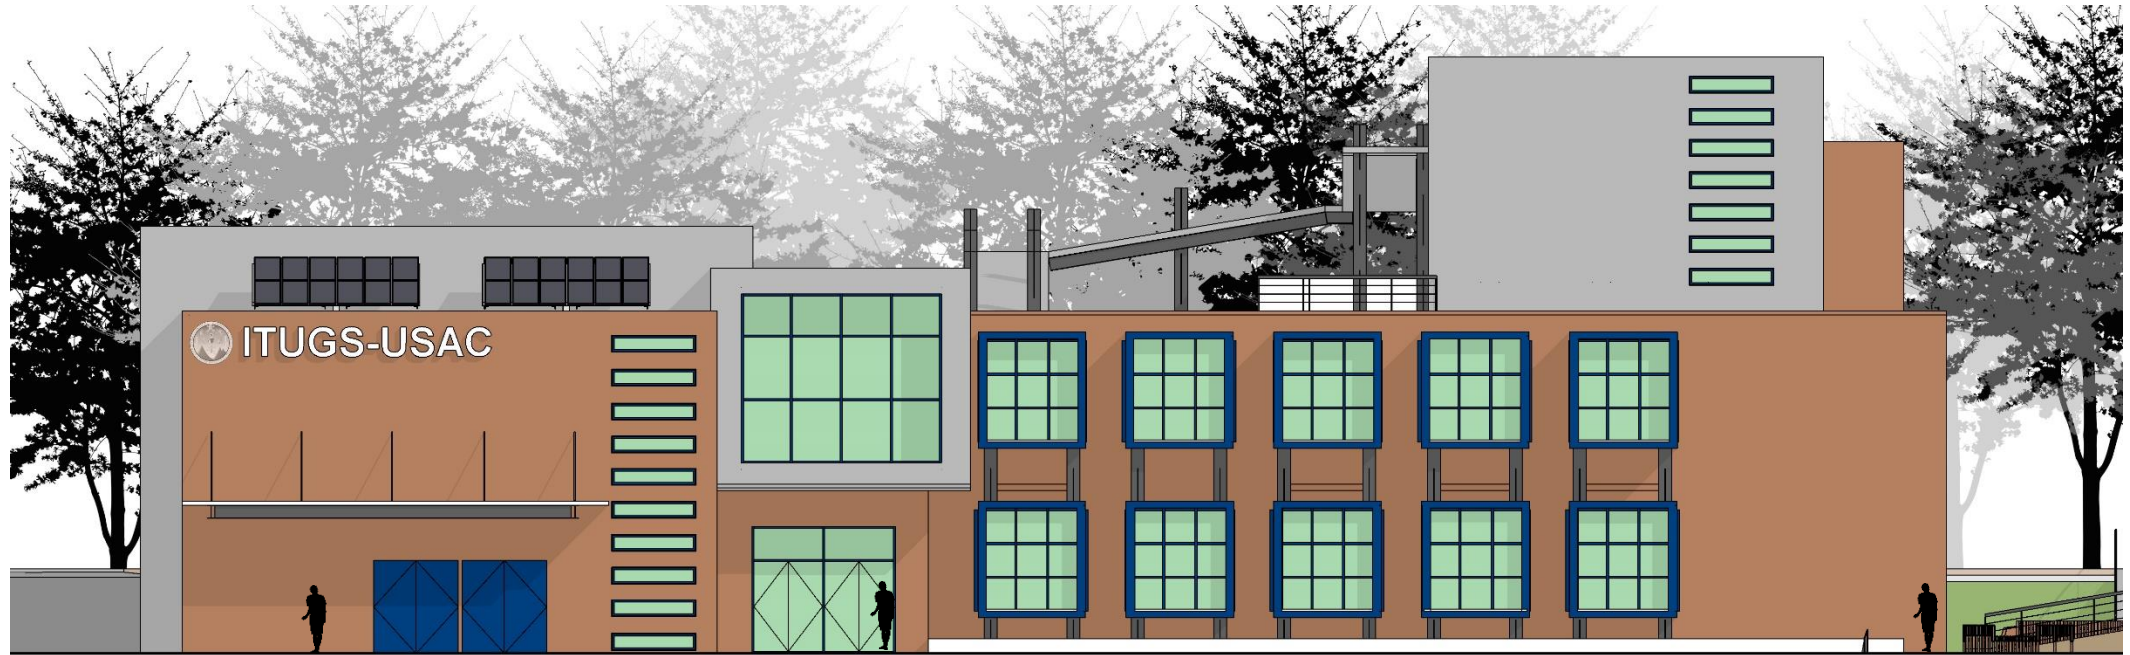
Elevación Sur-Oeste. Fuente: Elaboración propia.
